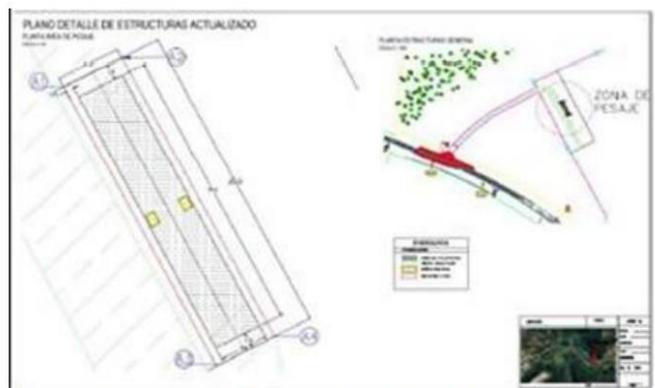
, de la Adenda. Plano detalle de lugar donde será instalado el sistema de pesaje.
